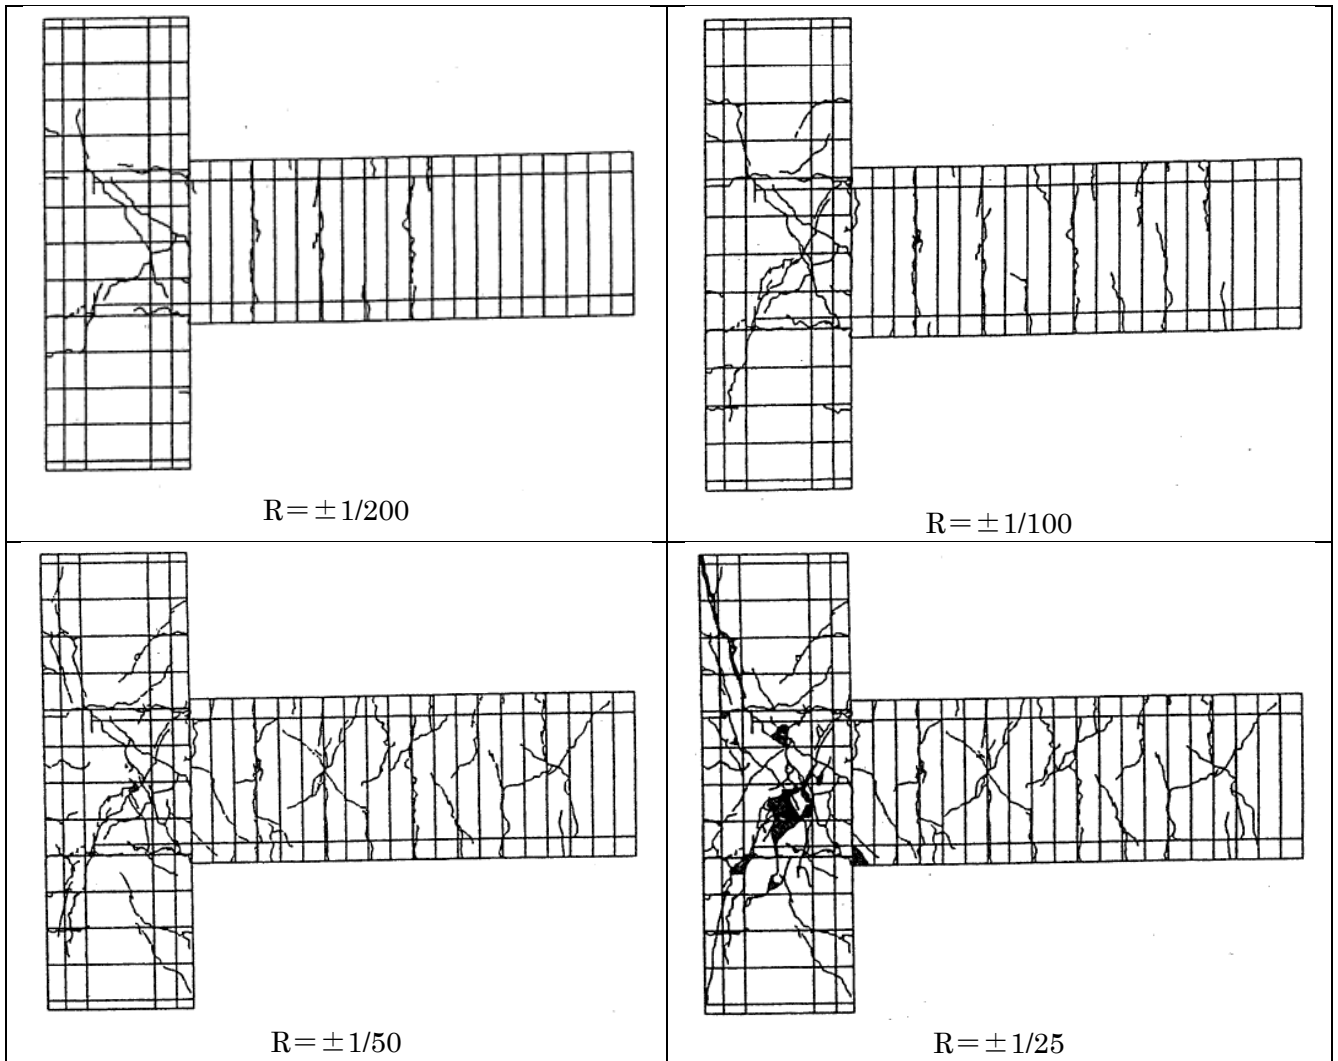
8. 1999No.9 試験体ひび割れ図
